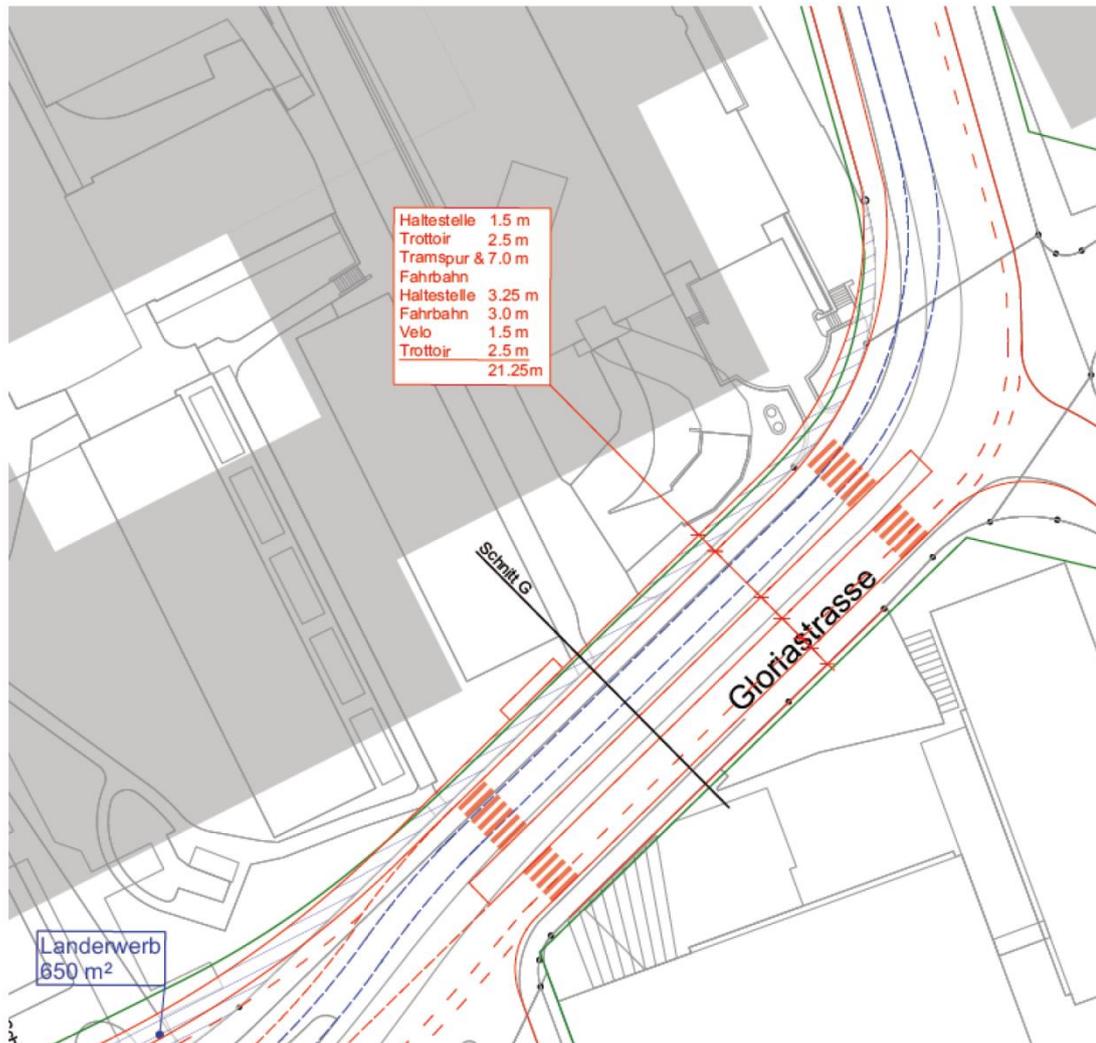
Situationsplan nach geplanter Verschiebung Haltestelle Platte
